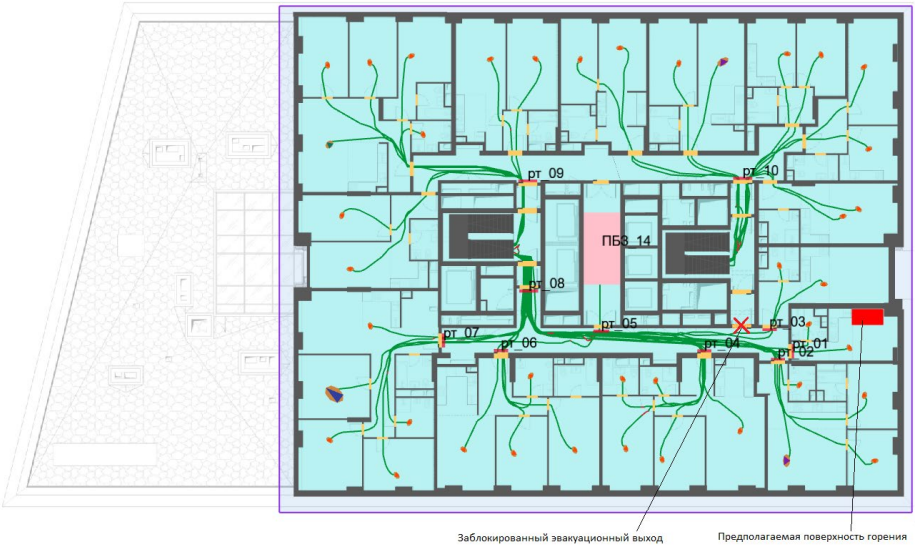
План 14-го этажа и нанесенная на него расчетная (принципиальная) схема эвакуации
